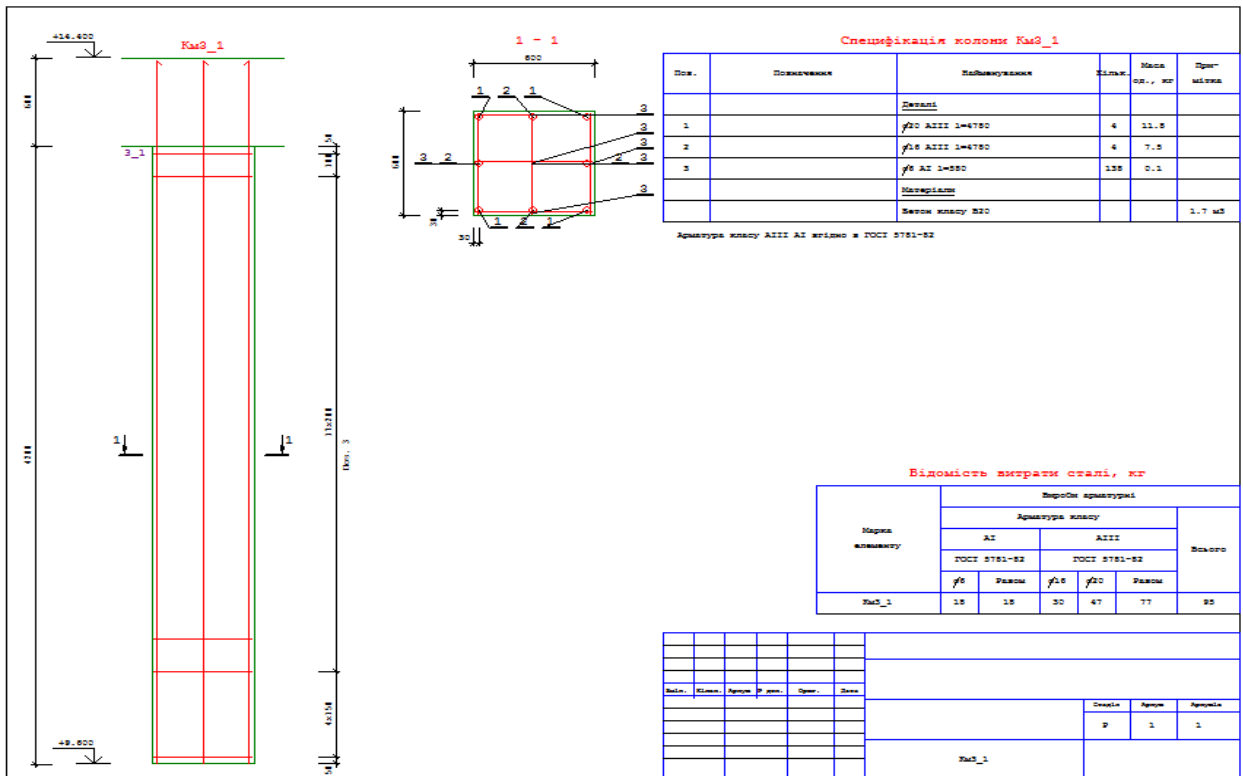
Варіант будівлі з балочно - плитним перекриттям. Колонна К3-1. Креслення робочого проекту.
